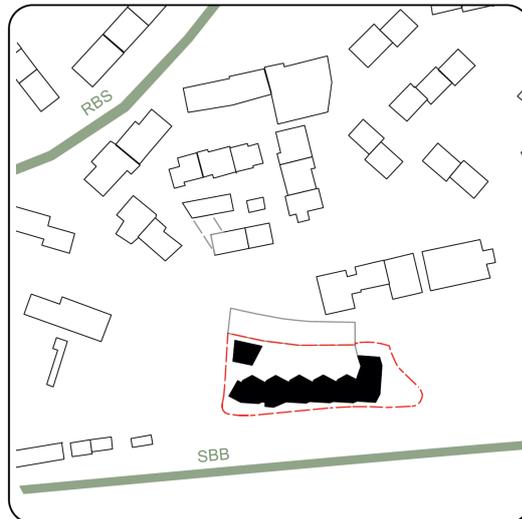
Schwarzplan der geplanten Bebauung (Quelle: AR3 Architekten)
